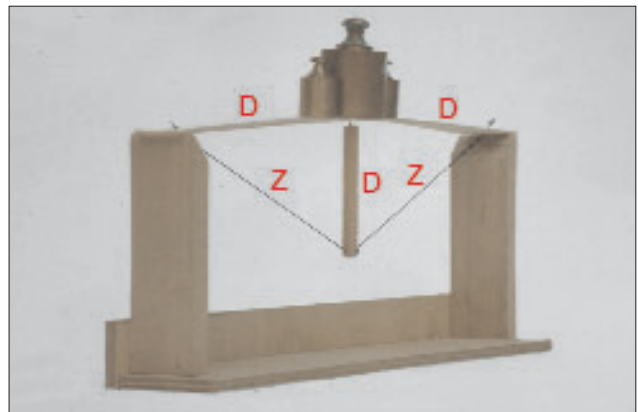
Zugband-Konstruktion zur Traglaststeigerung
